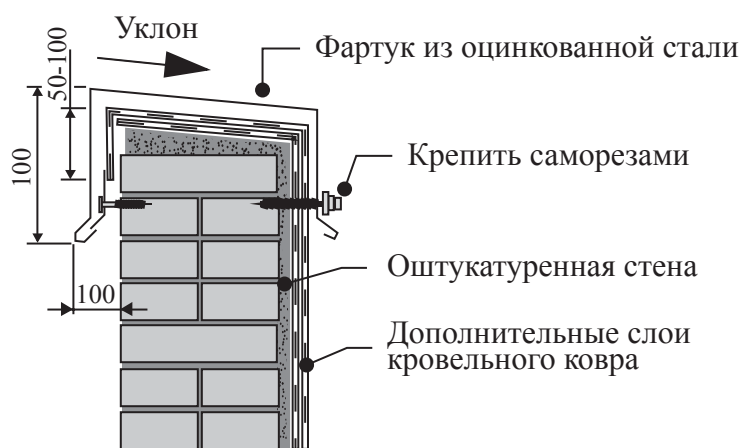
Примыкание кровельной системы к парапетной стене высотой менее 500 мм.
